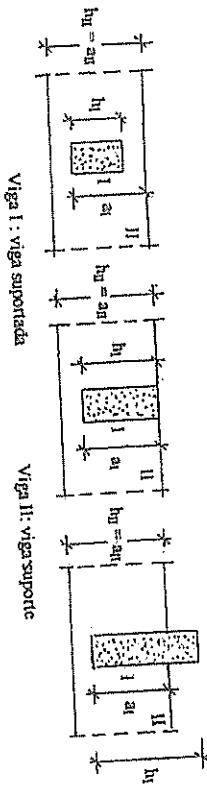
Viga suportada com face inferior acima da face inferior da viga suporte
